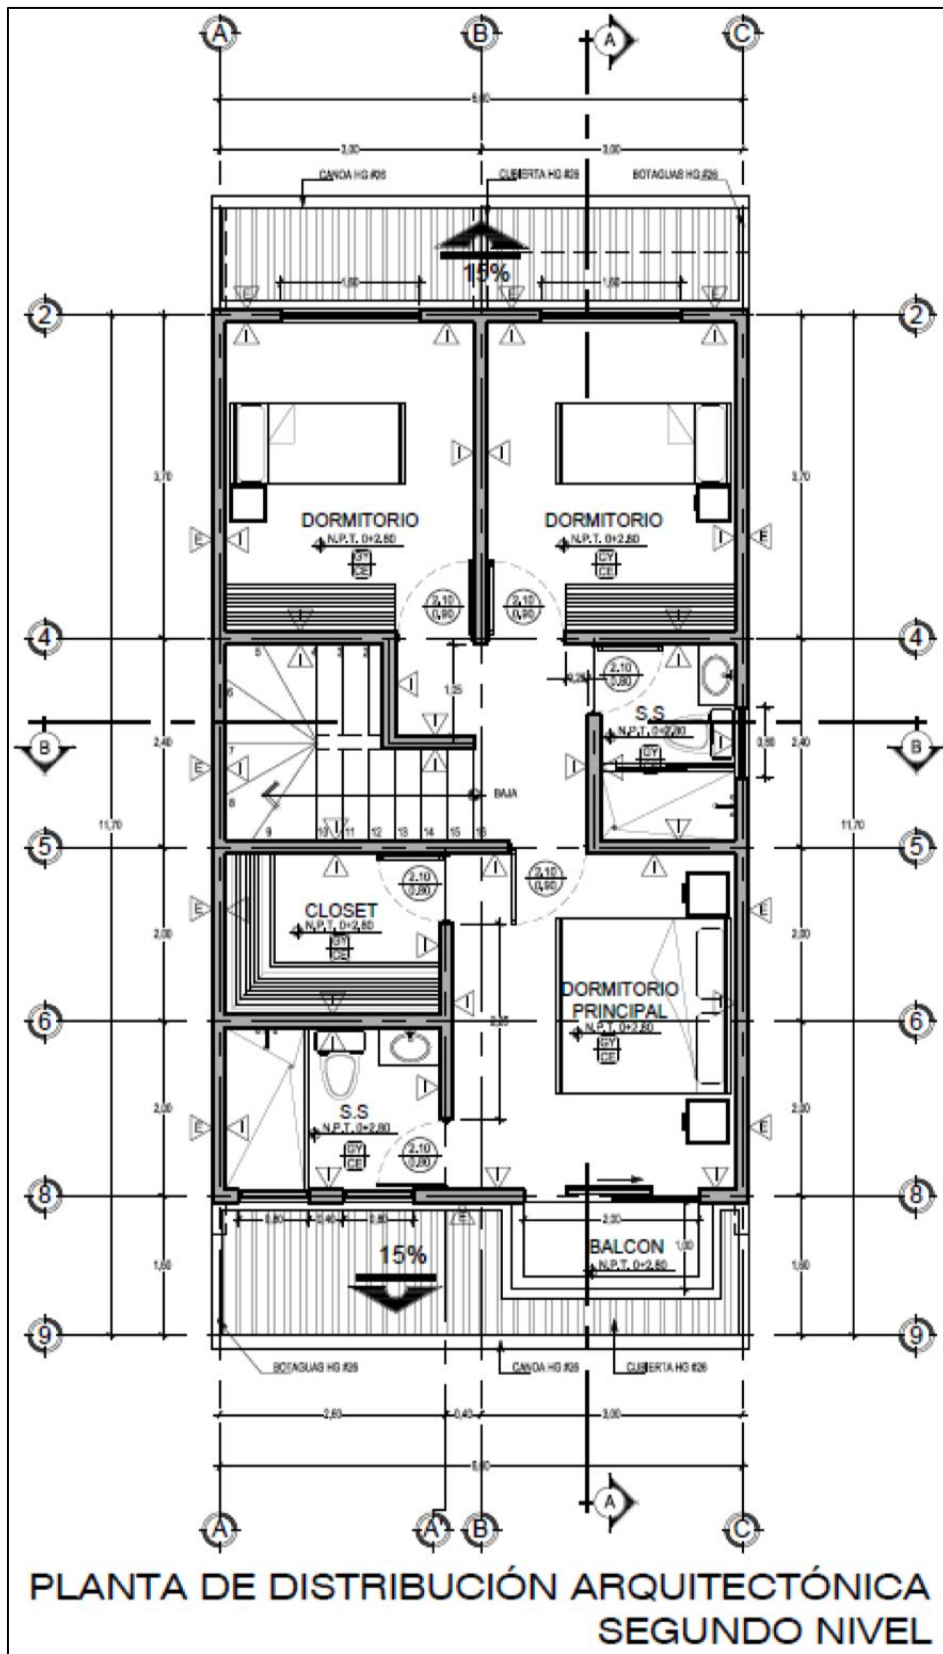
Plano arquitectónico de la vivienda utilizada: Segundo Nivel
